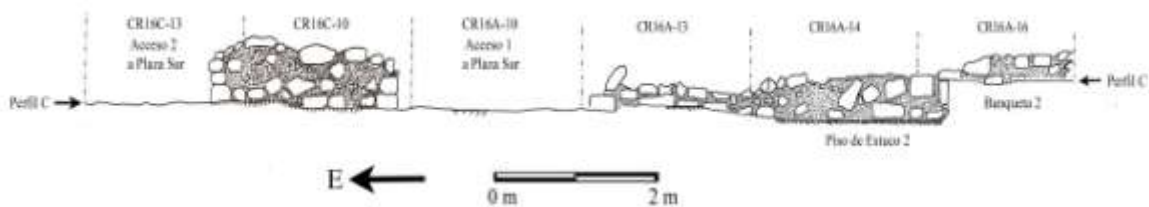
Elevación Norte de Muro Sur (Perfil C) (Dibujo: V. Orellana y A. Cajas. Calco: J. Ponce)
